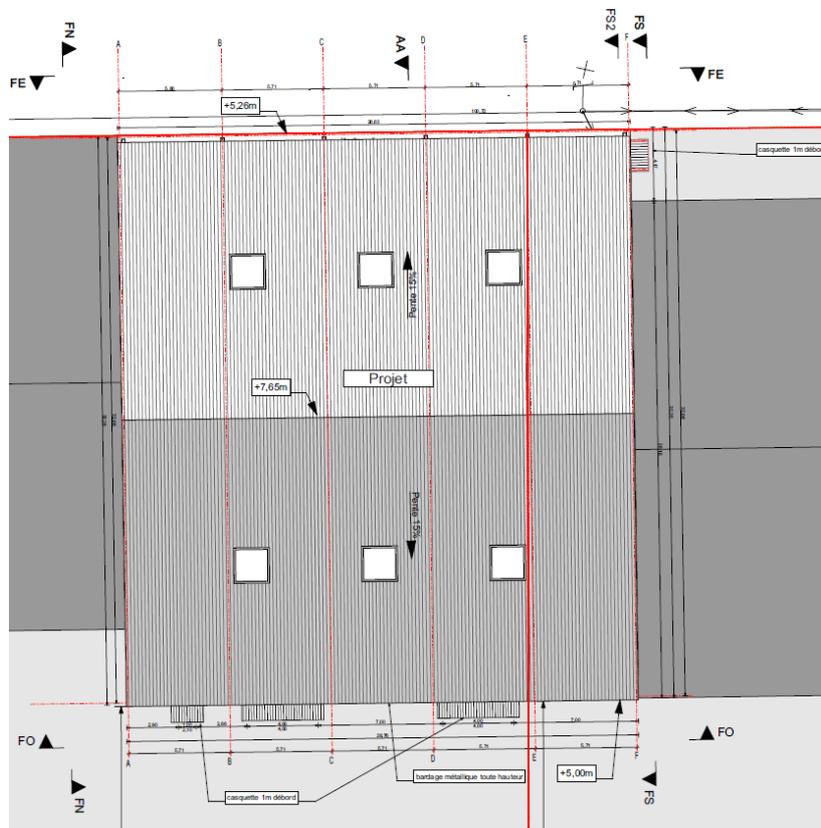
Plan du futur bâtiment usinage bois (au centre)
